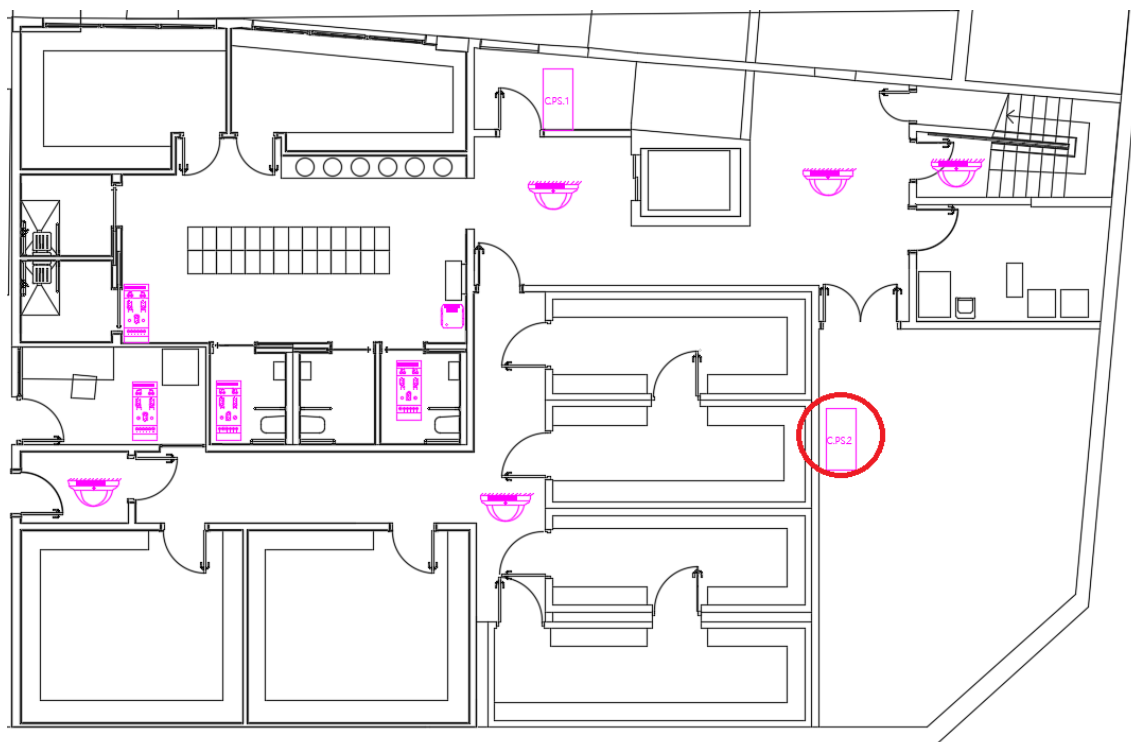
Ubicación del cuadro ubicado en la sala de máquinas de la planta sótano (C.P0.2).
